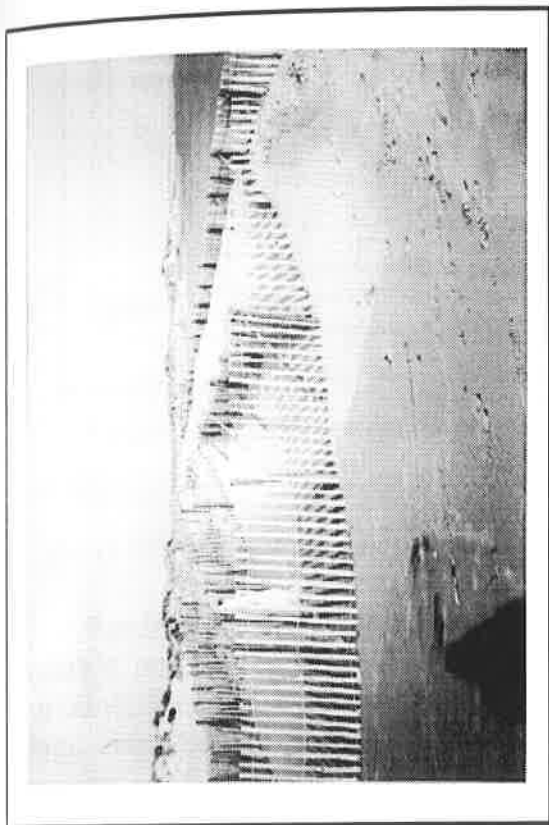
Installation de brise-vents (ganivelles) au pied du cordon - plage de Piémanson
